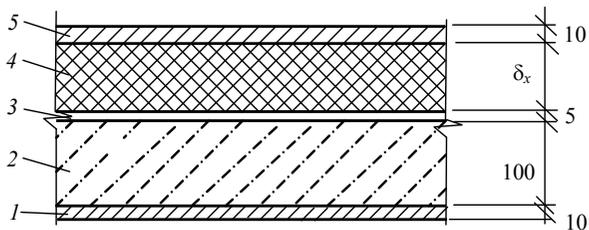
Вариант 2-й конструкции чердачного перекрытия:
